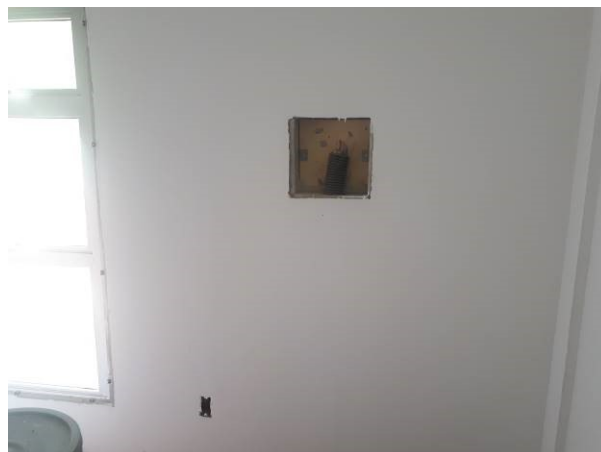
E: infraestrutura para cabeamento estruturado - caixas DG PAB e OAB
